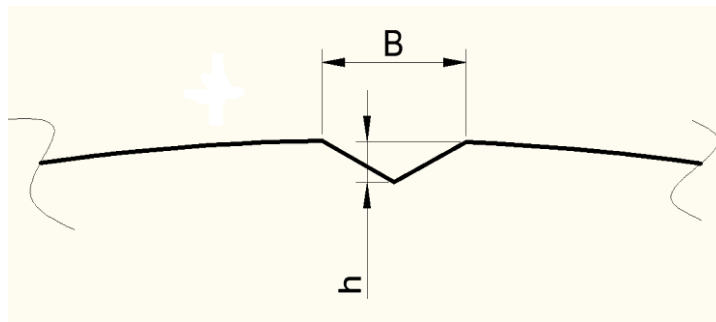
Варьируемые параметры дефекта вертикального монтажного сварного шва.
